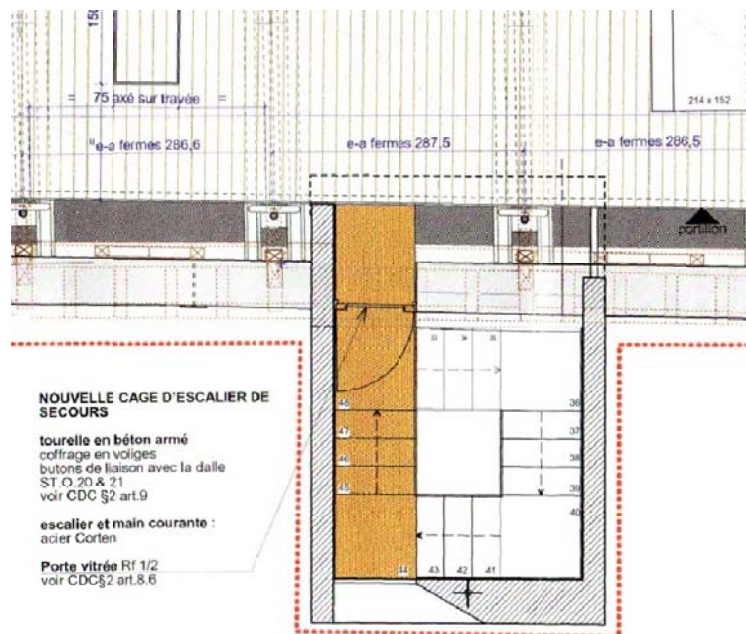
Vue en plan de la tourelle d'escalier (Plans-d'exécution, 2007)
